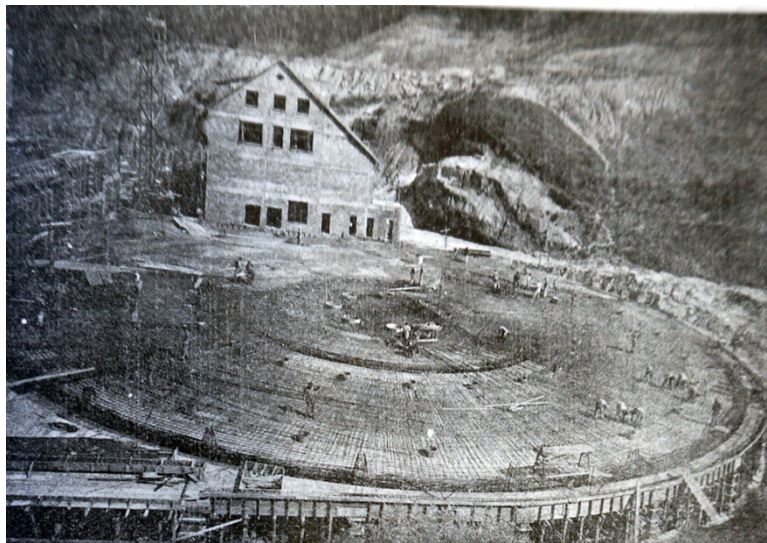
Teto do subsolo da Pista de Gelo. Ferragem da laje em forma de anel circular. FONTE: CONCRETO, 1943.
